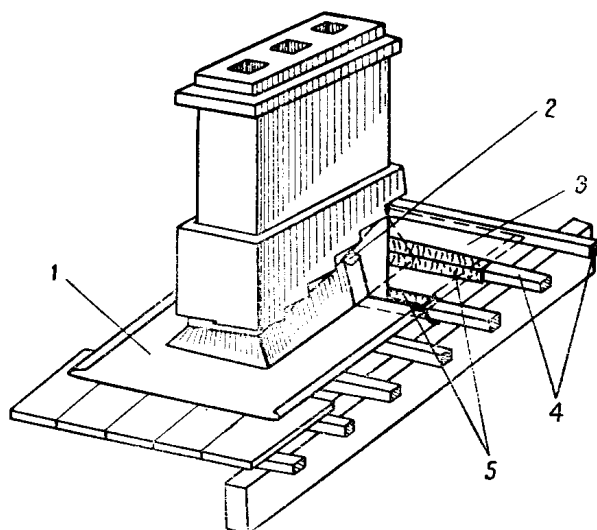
Устройство металлического воротника вокруг дымовой трубы
